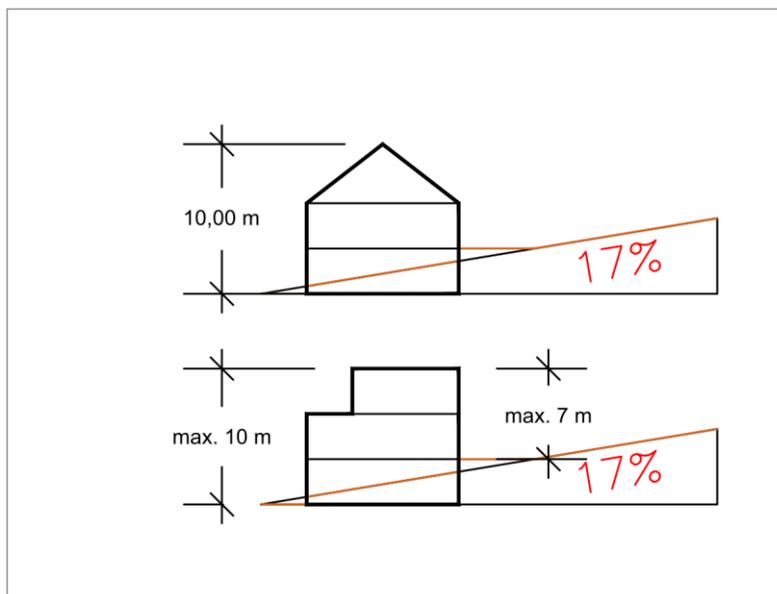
Prinzipskizze Hangbebauung mit Gebäudehöhen für First und Außenwand.
